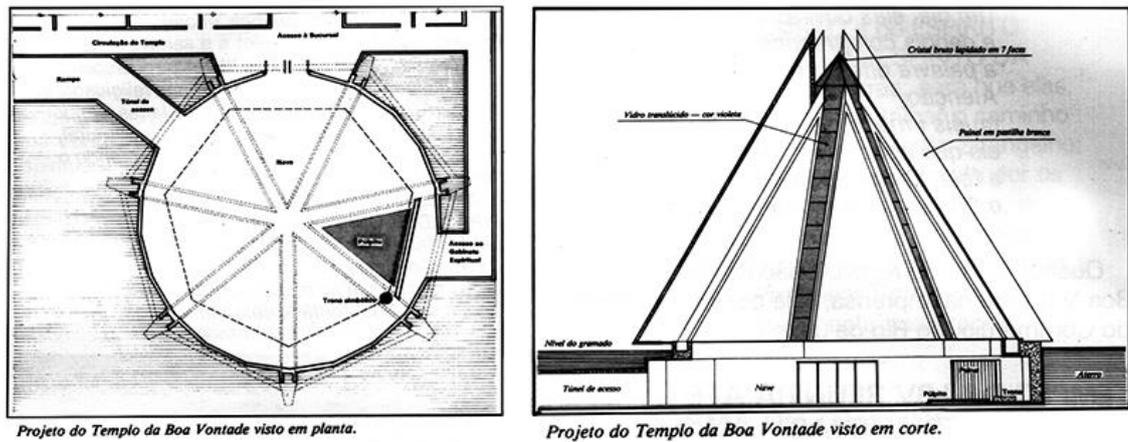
Planta baixa e corte do Templo da Boa Vontade.
